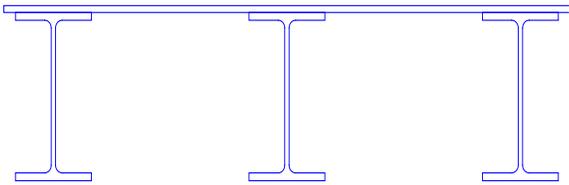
Ортотропная конструкция с открытыми ребрами. Без нагрузки
